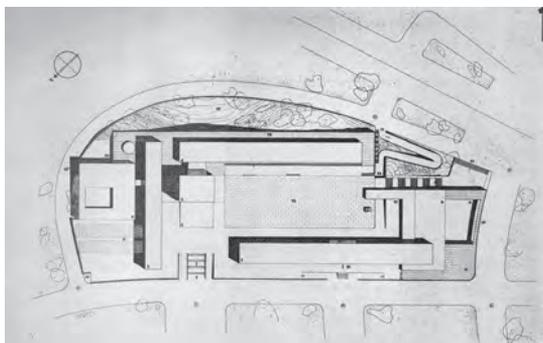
Bottoni, Mucchi, Pucci. Progetto per la piazza delle Forze armate all'E42, 1937. Planimetria generale. Milano, APB.
